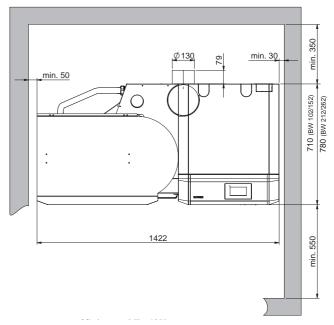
BioWIN 2 Hybrid – vista dall'alto
